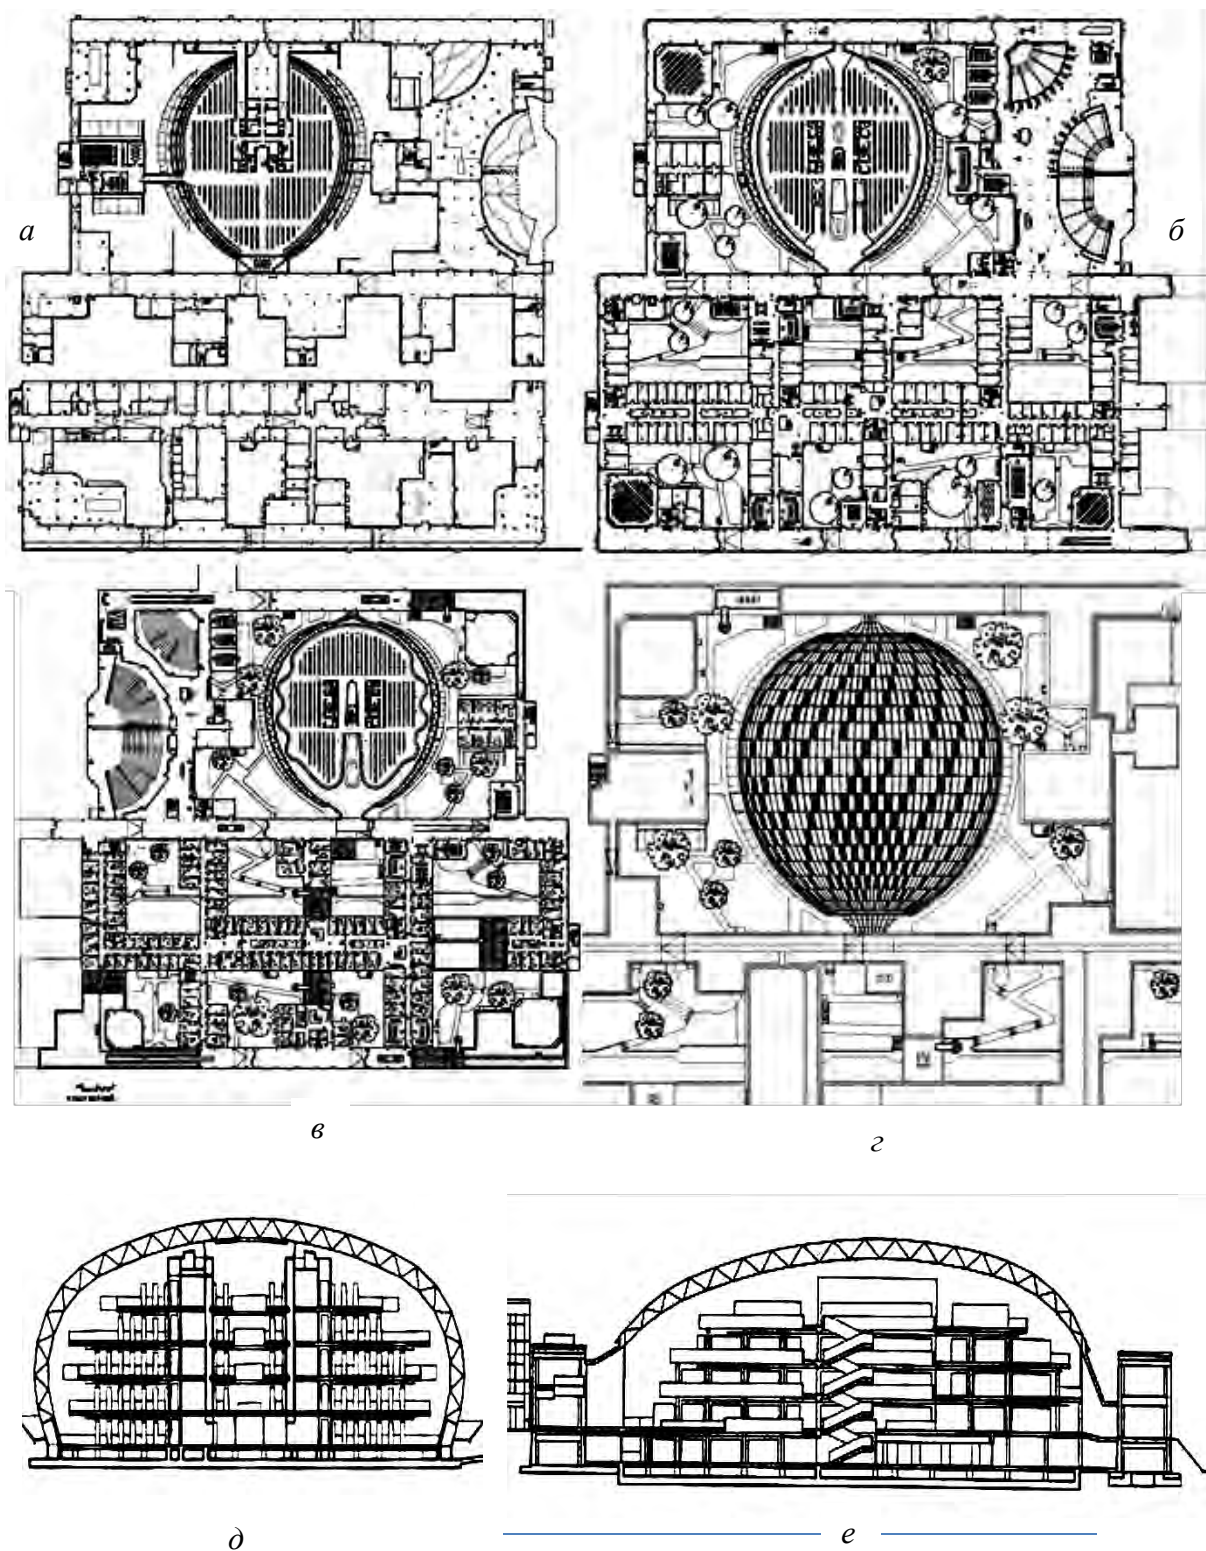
а – первый этаж; б – второй этаж; в – третий этаж; г – генплан; д – поперечный разрез; е – продольный разрез
